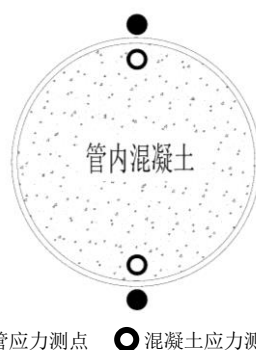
6 混凝土钢管拱断面应力测点布置示意图
